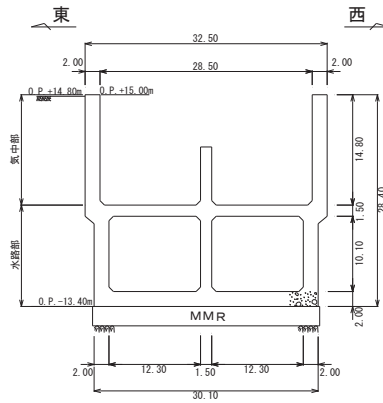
海水ポンプ室断面図 (A-A 断面, 東西 (スクリーンエリア))
